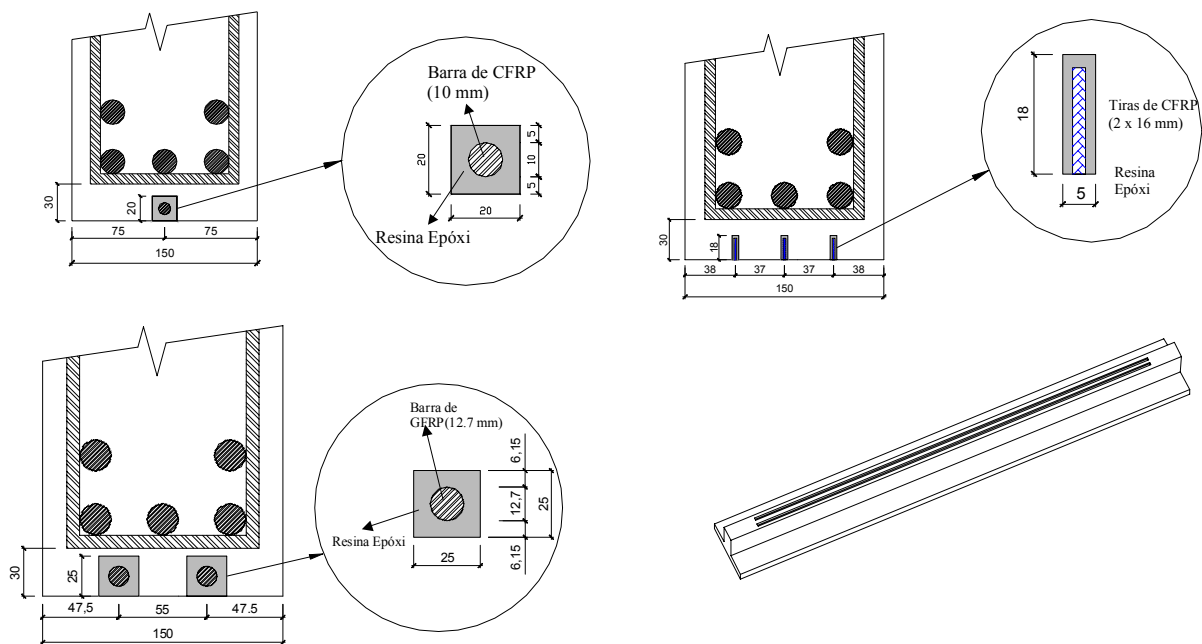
Sistema de reforço aplicado (Lima, 2004)
